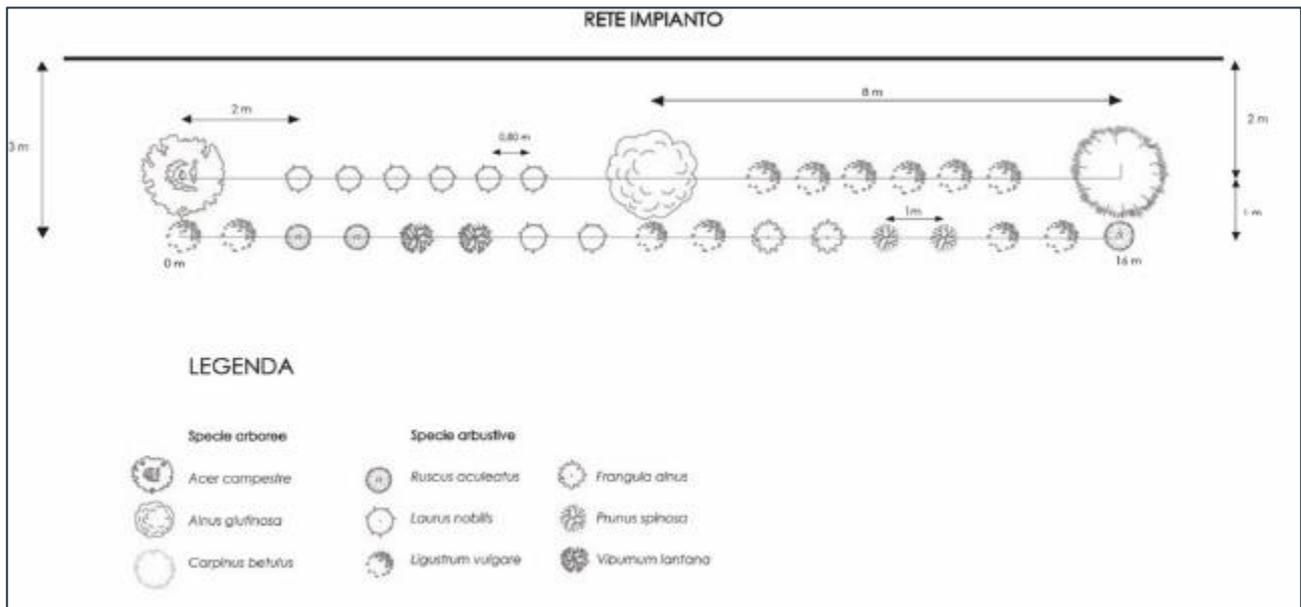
Schema impianto fascia di mitigazione di 3 metri
